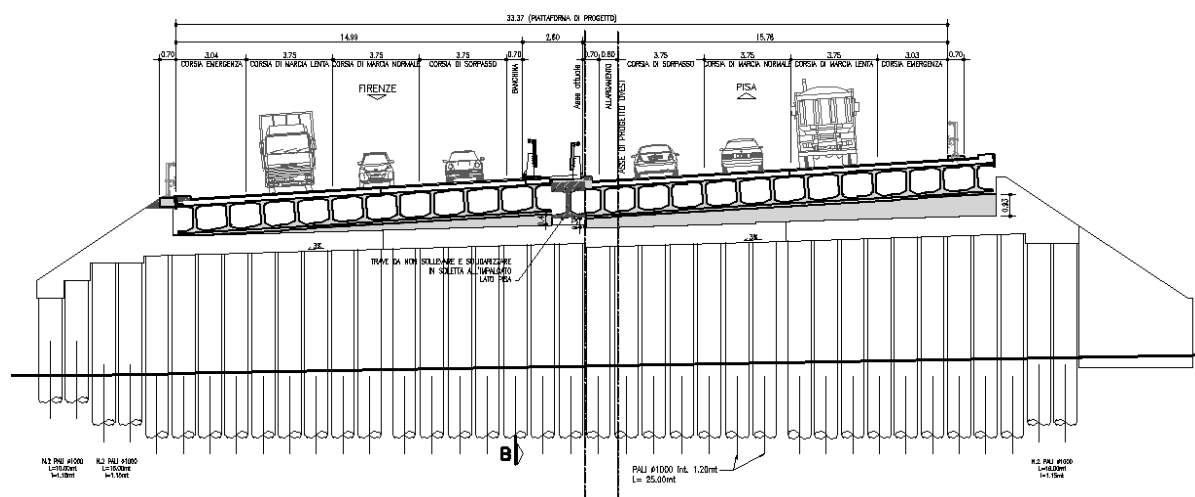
Sottovia seconda tangenziale Ovest di Prato. Sezione trasversale
